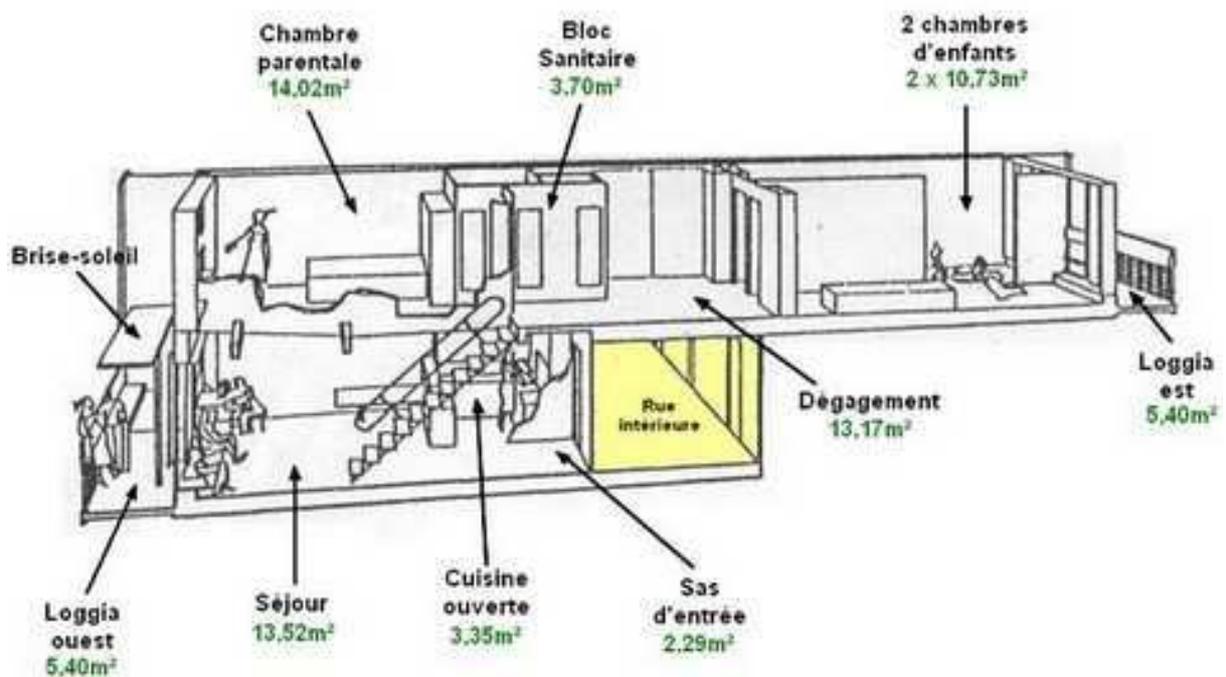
Vue en coupe d'un appartement montant de type IV. Détail des superficies. Fond de plan FLC.
